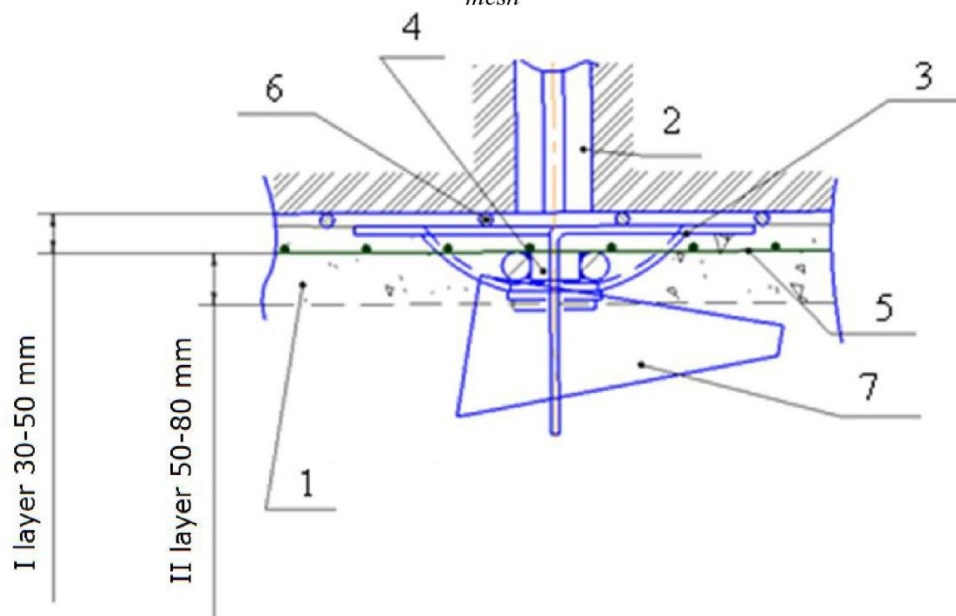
Конструкция комбинированной крепи СЗА–Армокрепь–УКК: 1 – торкретбетон; 2 – СЗА; 3 – опорная плита СЗА–УКК; 4 – арматурный фиксатор; 5 – сетка УКК; 6 – армокаркас; 7 – клин
